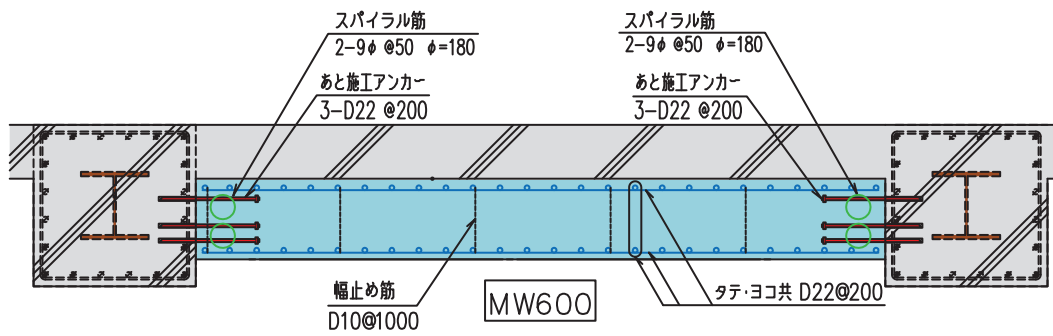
追設耐震壁配筋詳細 (B-B 断面図)
